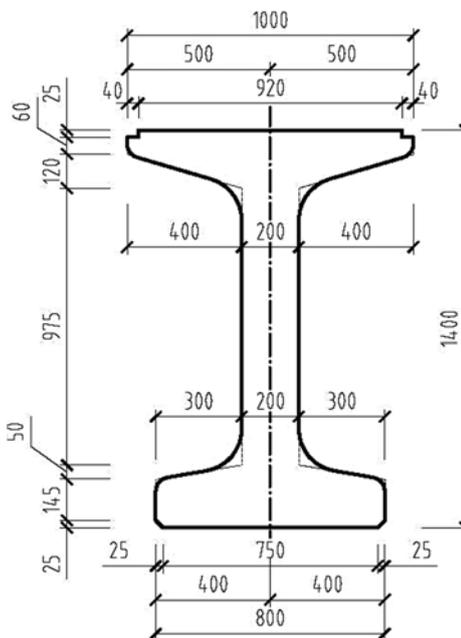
Sección tipo de viga. Doprastav. Serie DPS.
